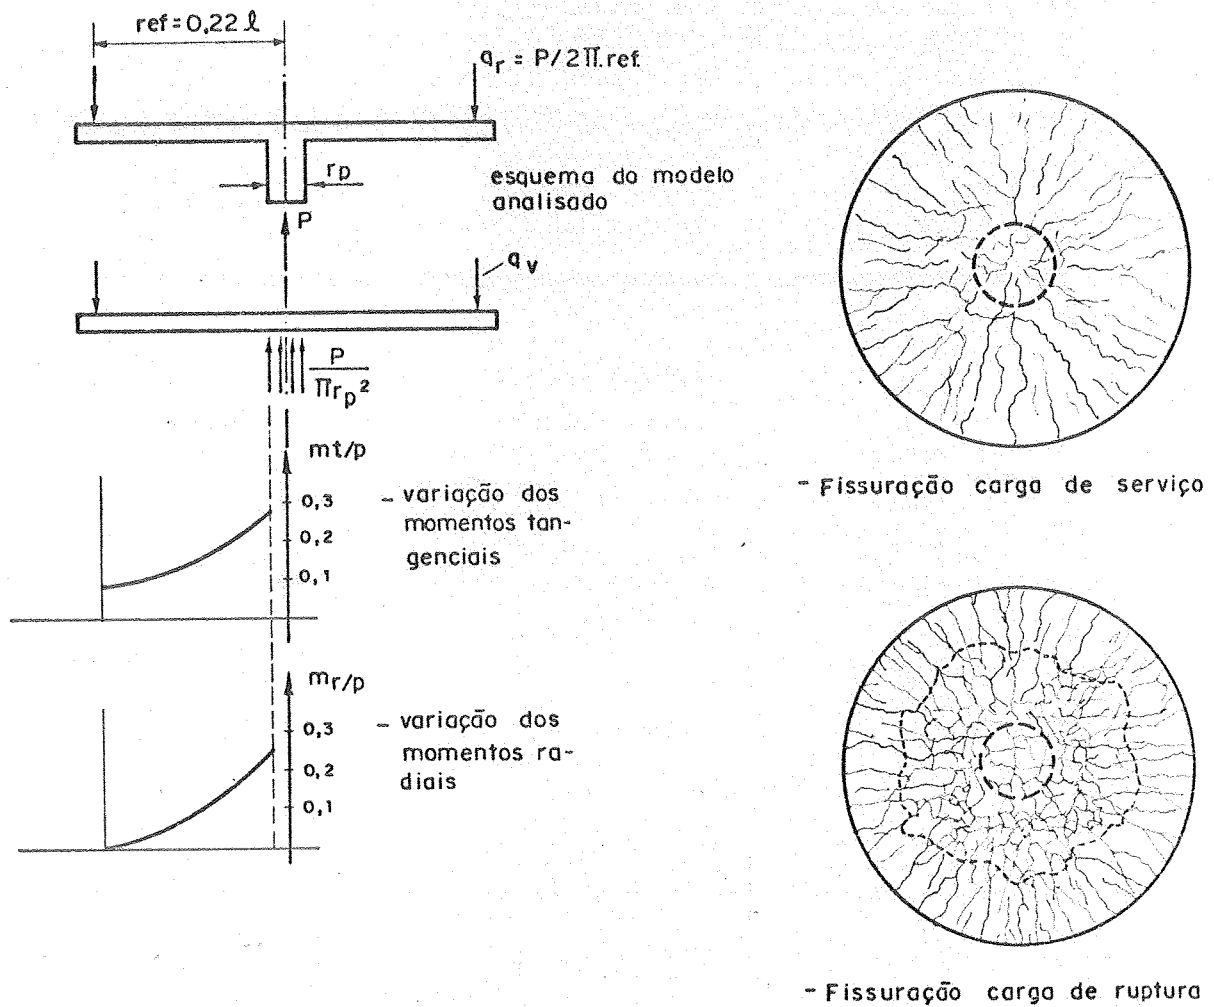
DISTRIBUIÇÃO DOS MOMENTOS RADIAIS E TANGENCIAIS - FISSURAÇÃO
